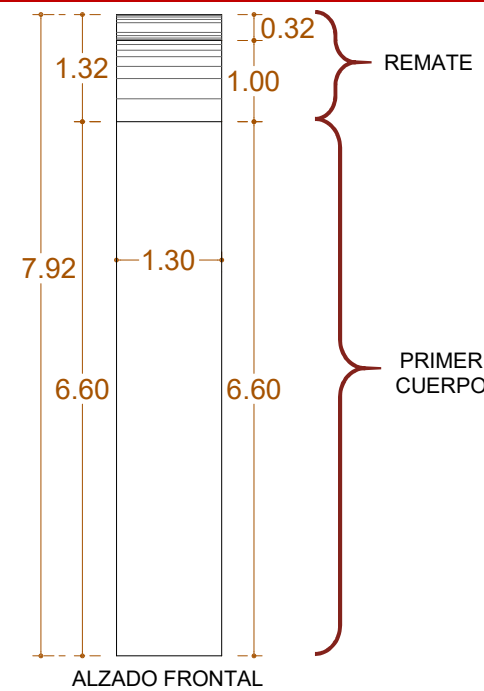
Vista poniente del contrafuerte de Eje 6 fachada norte
